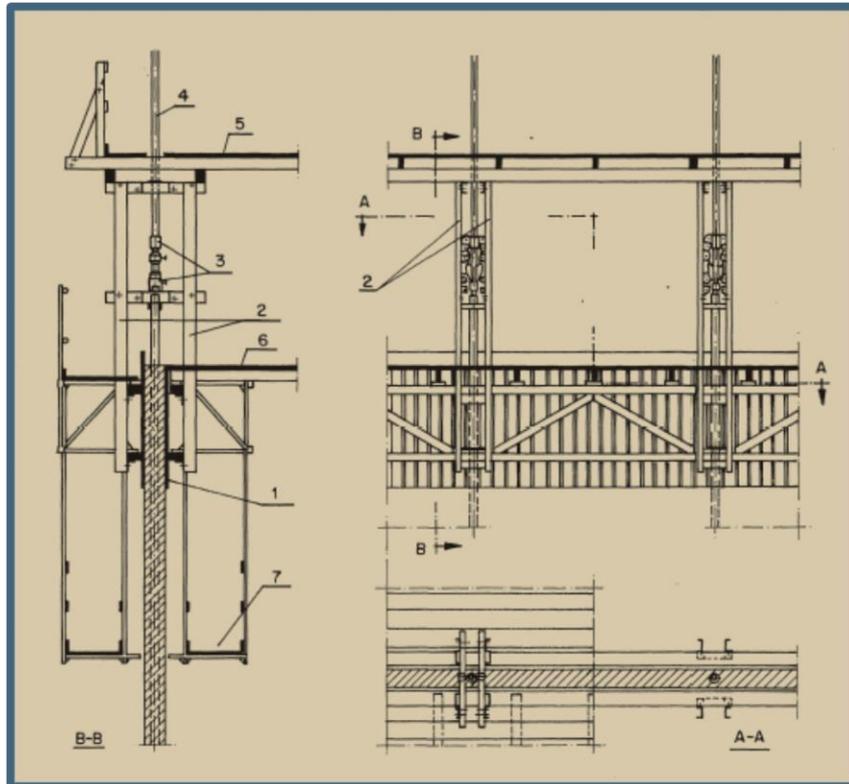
Encofrado Deslizante para Construcciones de Sección Constante.
